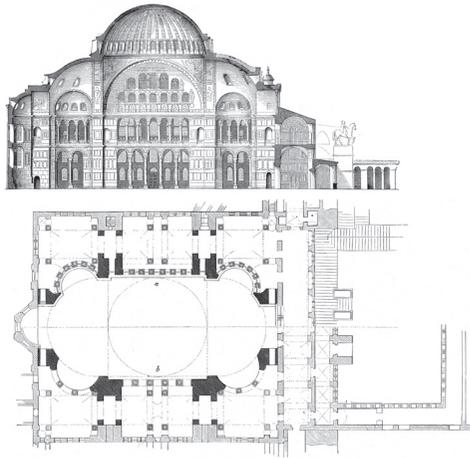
Planta y sección de Santa Sofía, Estambul. 532-537 d.c. [Paul Neff Verlag, 1908]
